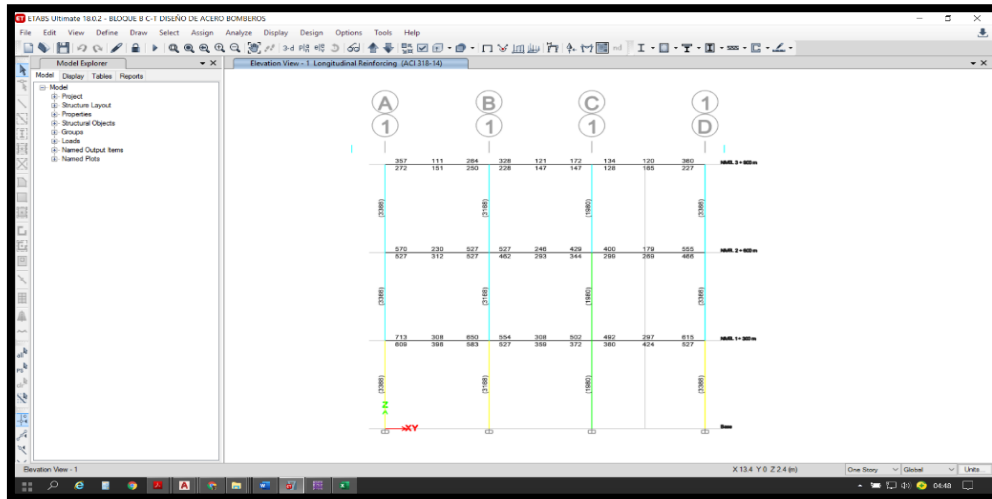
Bloque A - Acero longitudinal en el eje elevación eje 1-1
